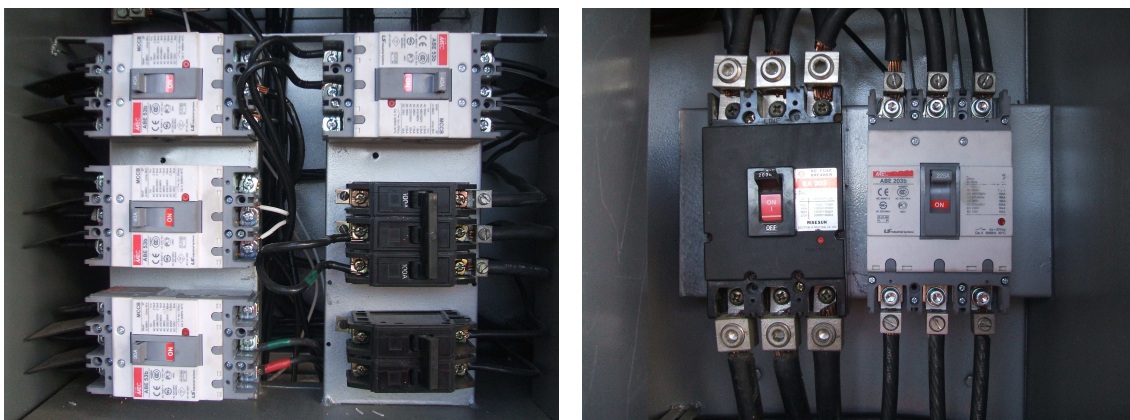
Breakers de seccionamiento instalados en el tablero de distribución principal
